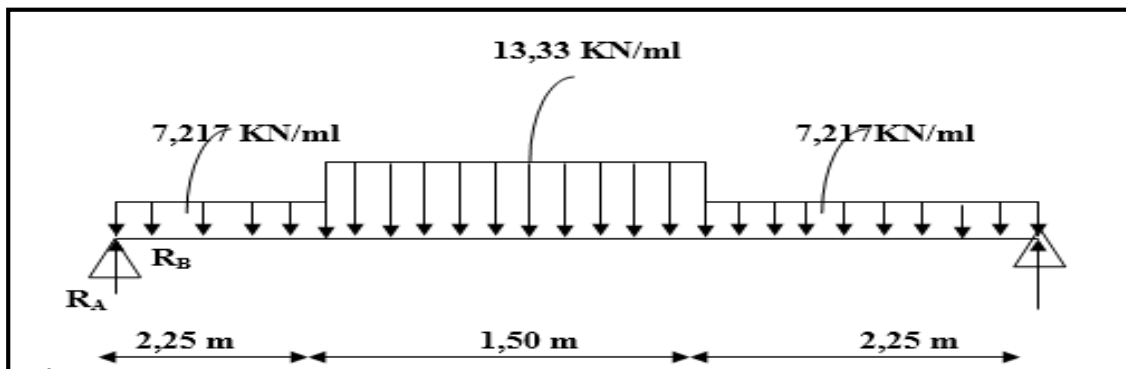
les charges permanent appliquées sur la poutre palière
